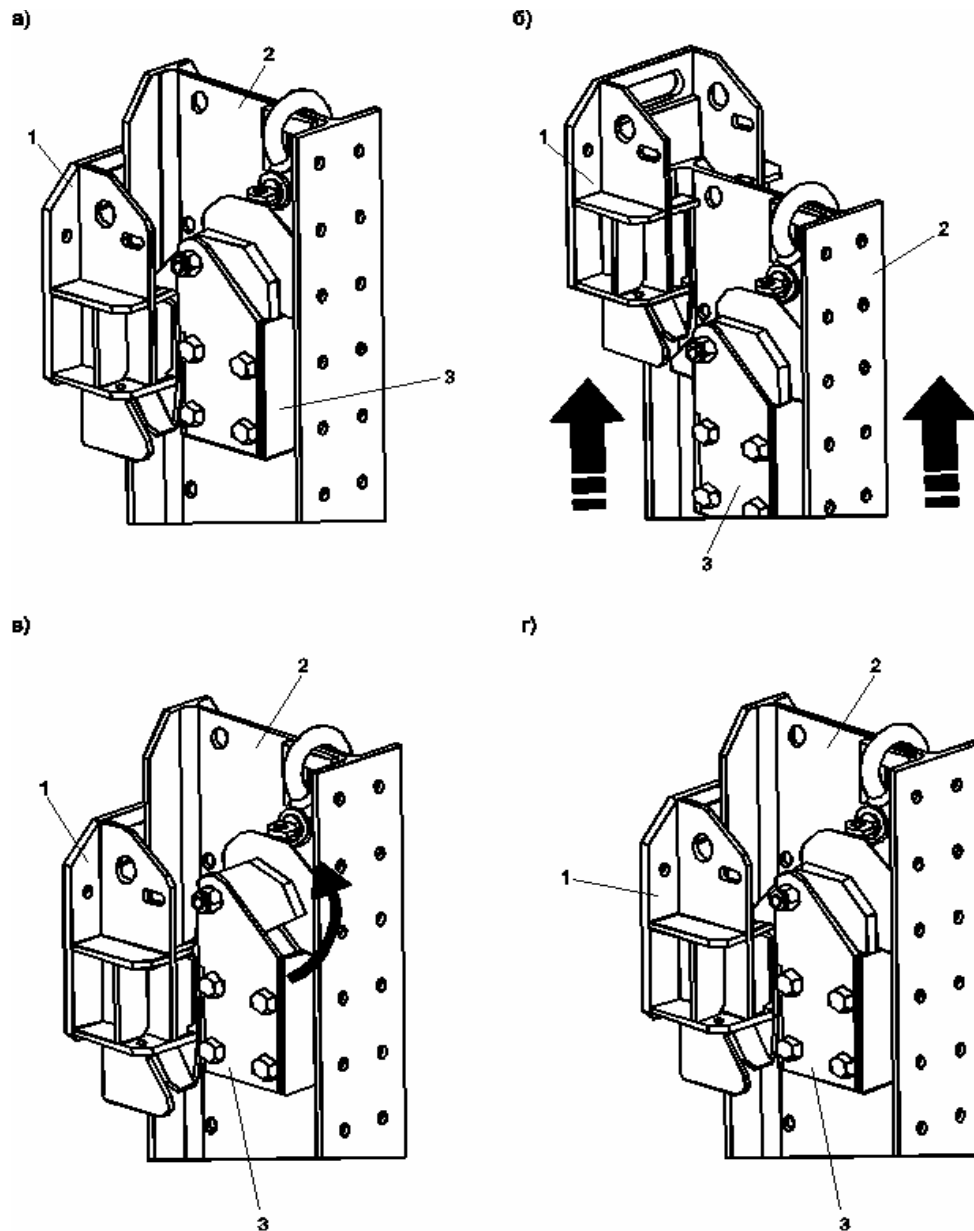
Последовательность перемещения опалубки по направляющим балкам: а — блок в исходной позиции; б — поднятие краном модульного элемента по направляющим балкам; в — поворот гравитационной защелки; г — блок опалубки зафиксирован в новой позиции:
